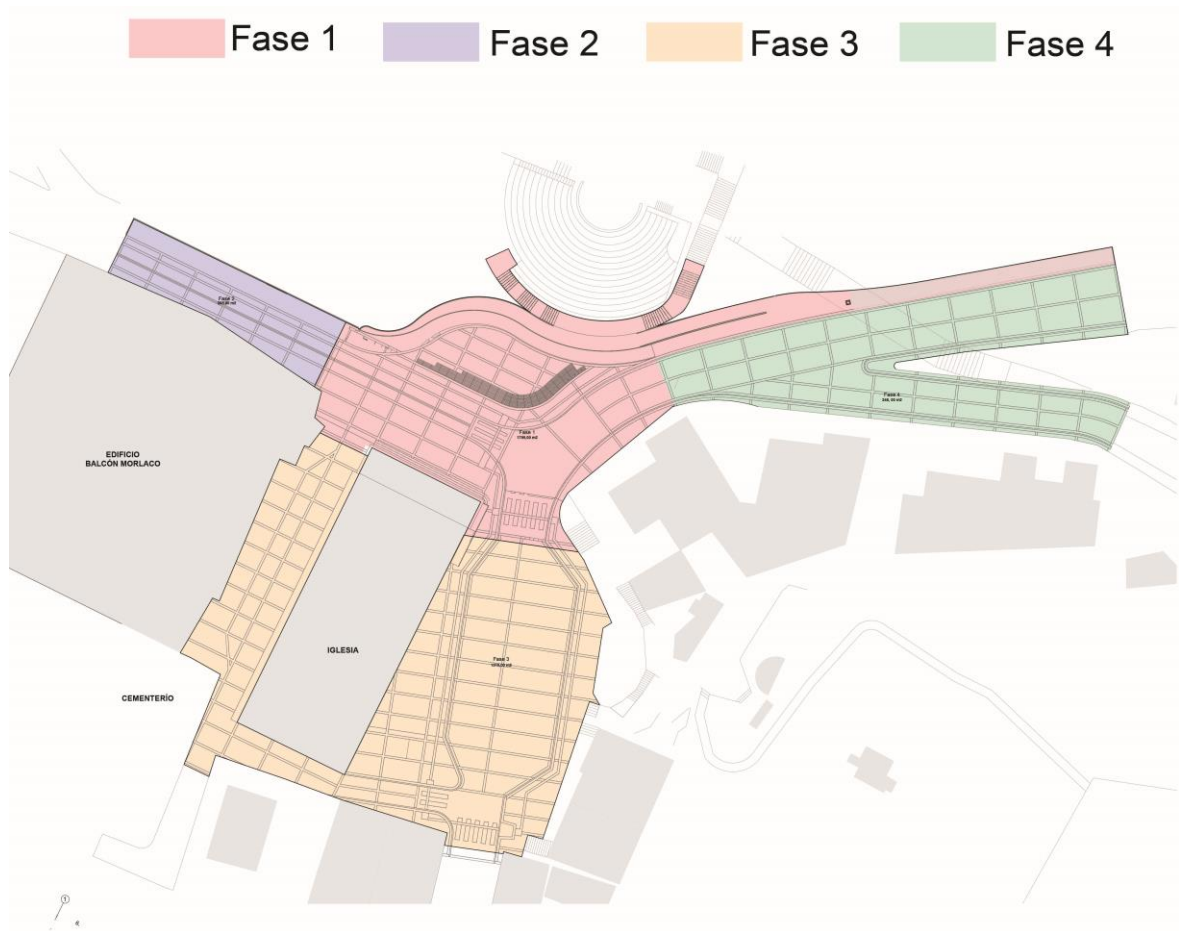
Emplazamiento general de la propuesta urbano-arquitectónica
